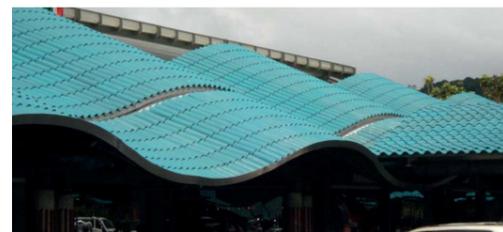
Ejemplo aplicación de la teja de Roofeco System.
